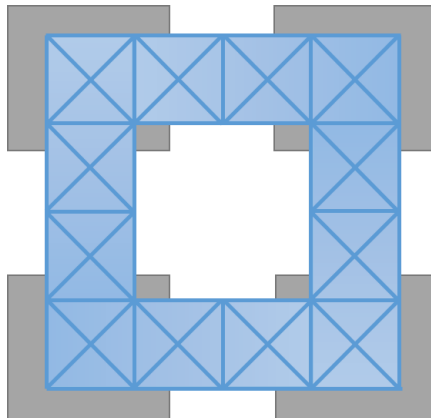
a Disposición en planta del sistema de fundación supuesto para los casos de estudio de este documento [elaboración propia]
